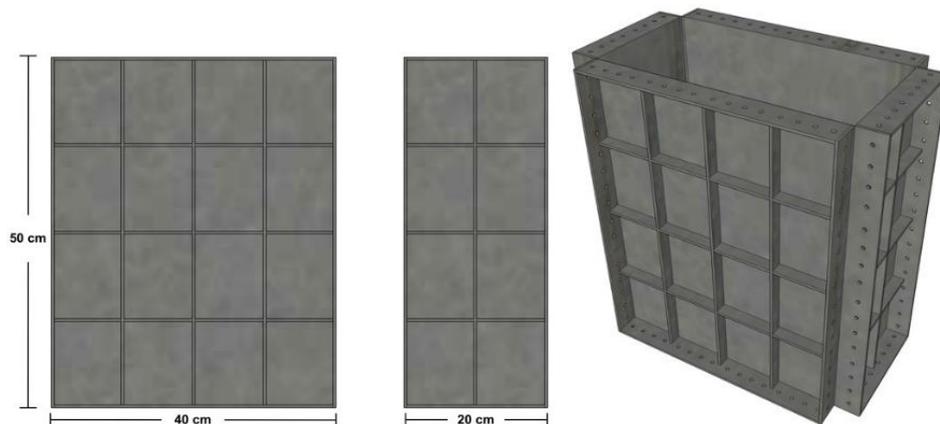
Dimensiones formaleta para construcción muretes (Autores)
